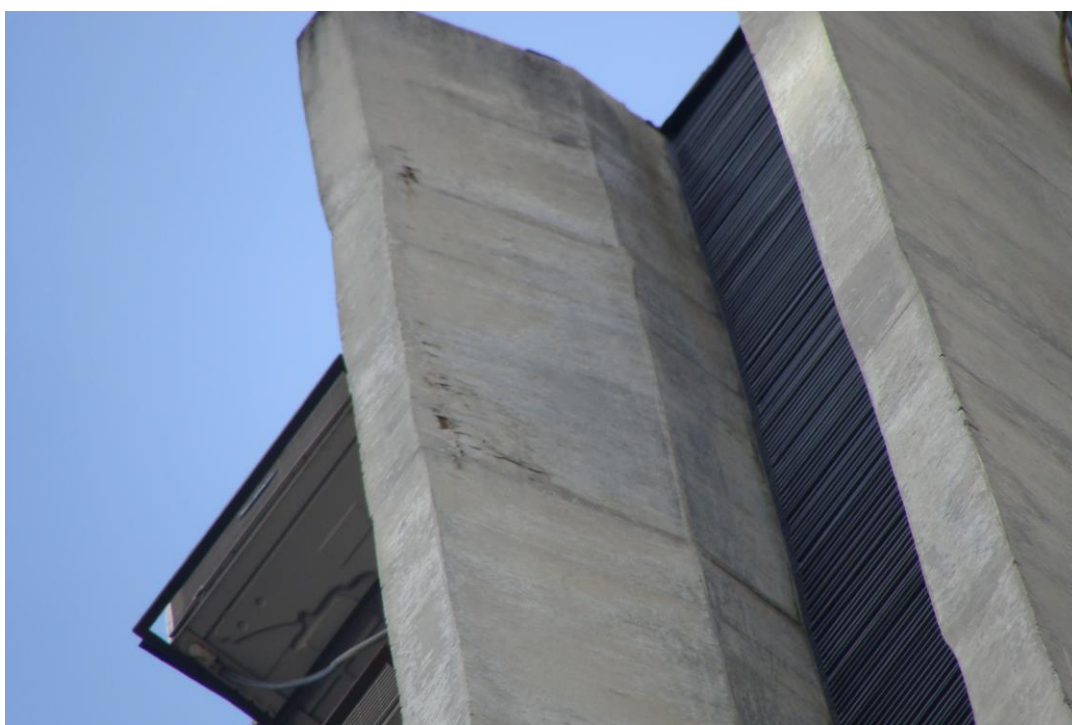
Armadura exposta pilar P12 (10º pavimento) (19/11/2013)
